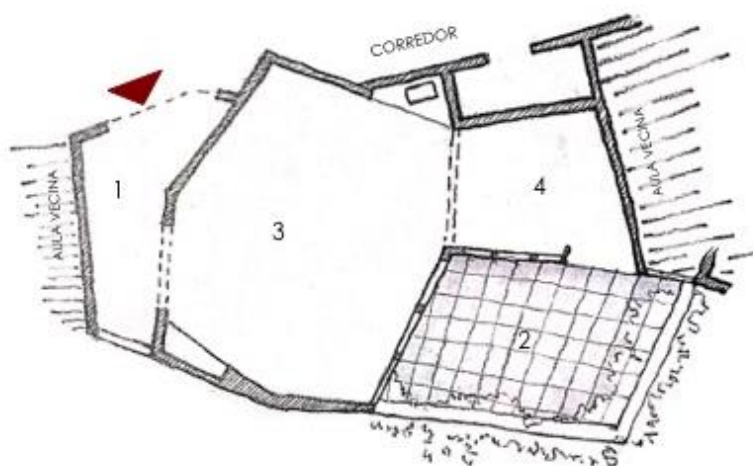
Planta aula tipo 2 Geschwister Scholl Schule.
